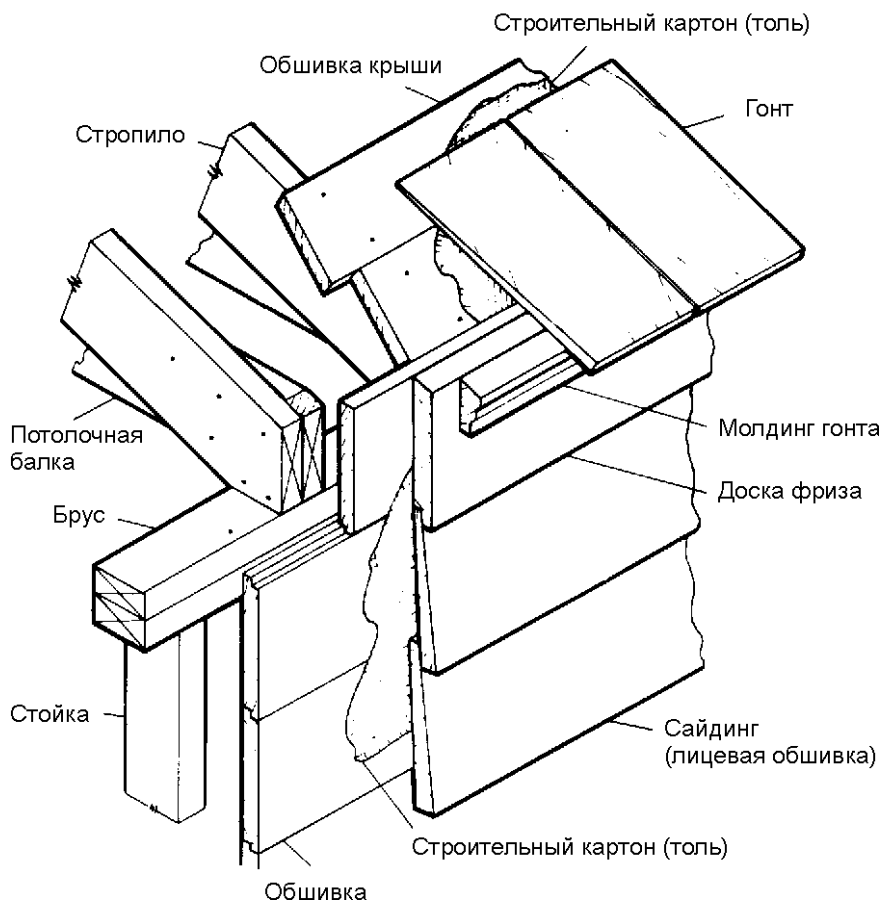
При коротких карнизах крыша не нависает над стенами (Forest Products Laboratory)
